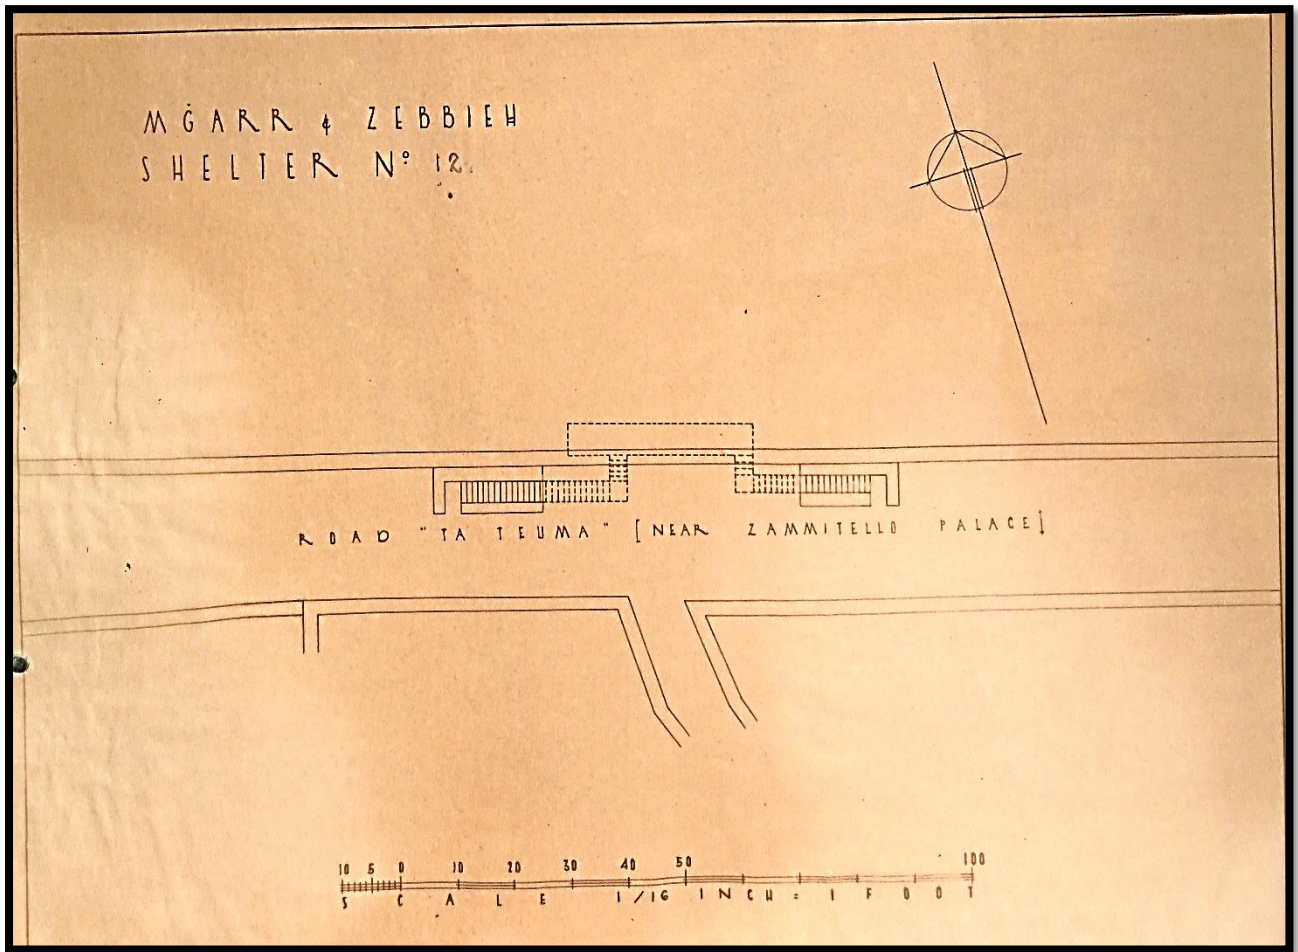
Planta do Abrigo nº12 "Road "Ta Teuma" [Near Zammitello Palace]"
